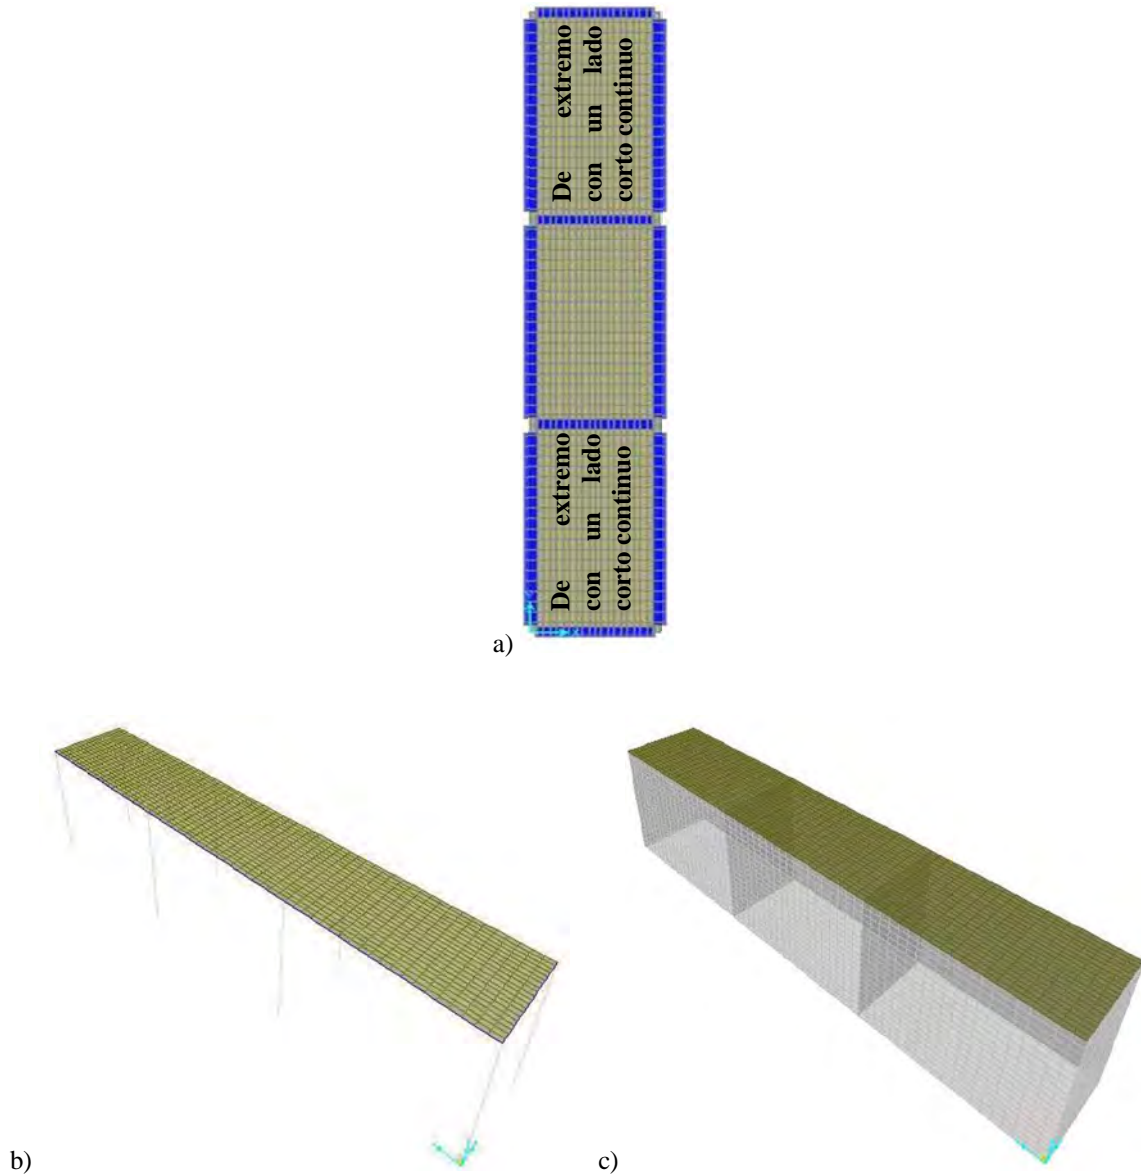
Paneles de extremo con un lado corto discontinuo: a) planta, b) apoyados sobre vigas y c) sobre muros.
